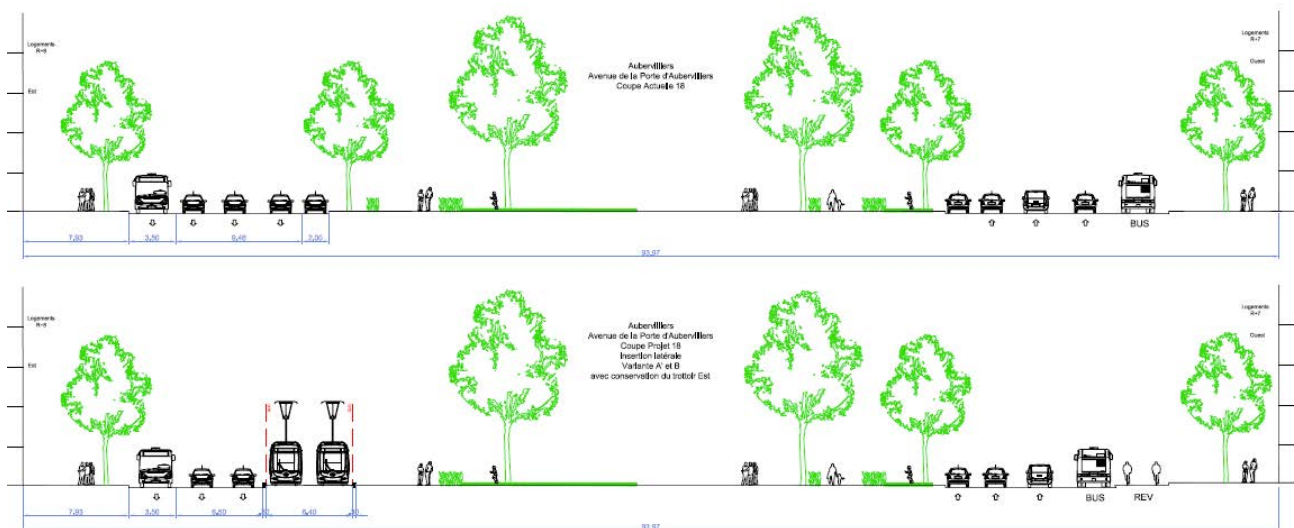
Insertion latérale de la plateforme Tram 8 sur l'avenue de la Porte d'Aubervilliers (coupe n° 18)
